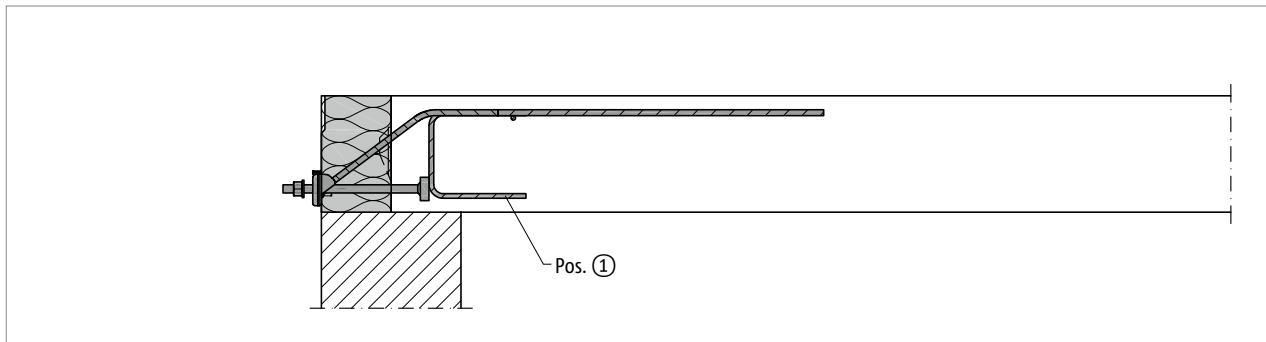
Schöck Isokorb® XT Typ SQP: Bauseitige Bewehrung, Schnitt
